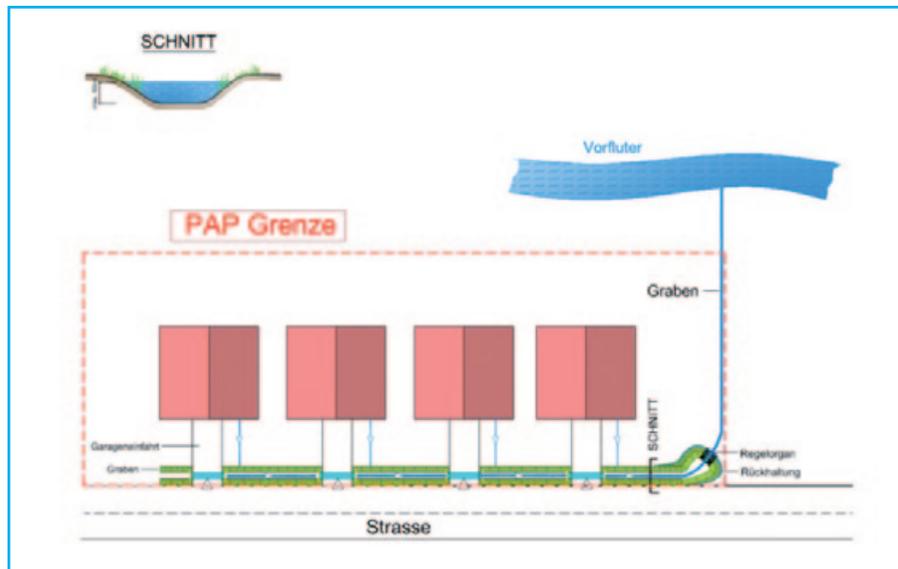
Beispiel einer Entwässerung von einem Bebauungsgebiet entlang einer Straße
